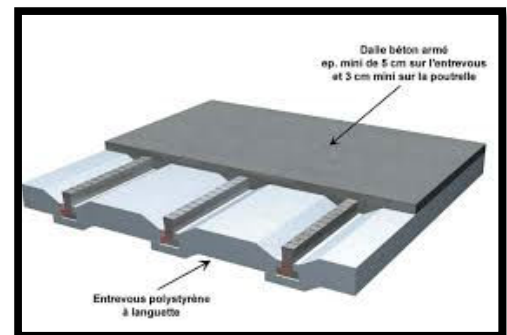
Le plancher poutrelle-entrevous³¹⁴
